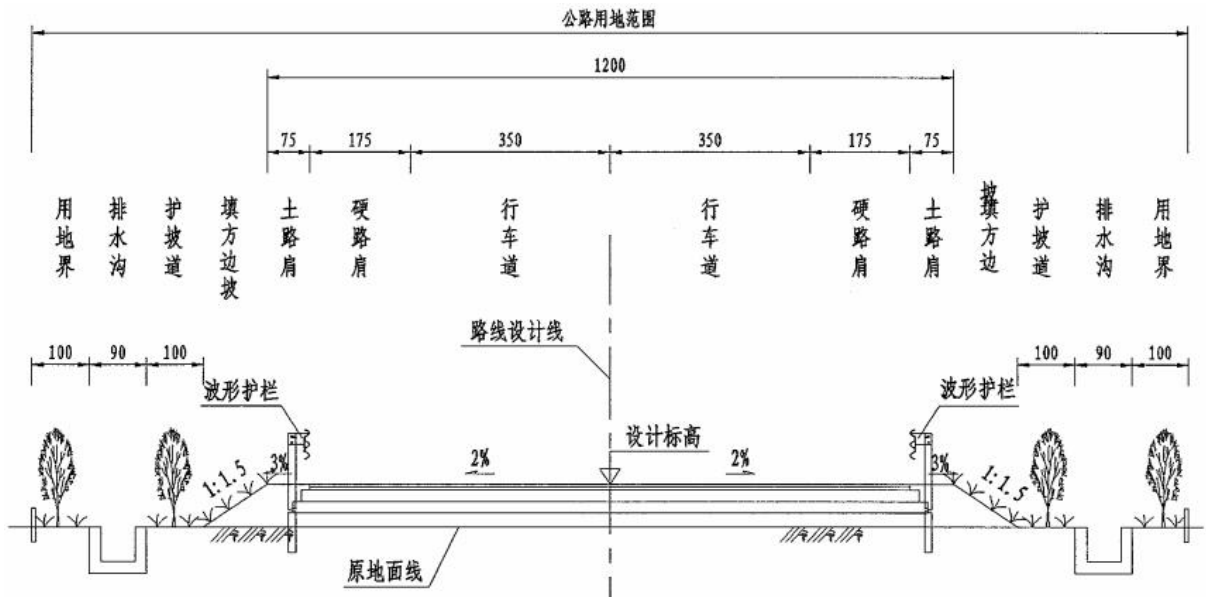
本改建项目 K10+605.66~K11+610 段路基标准横断面图
